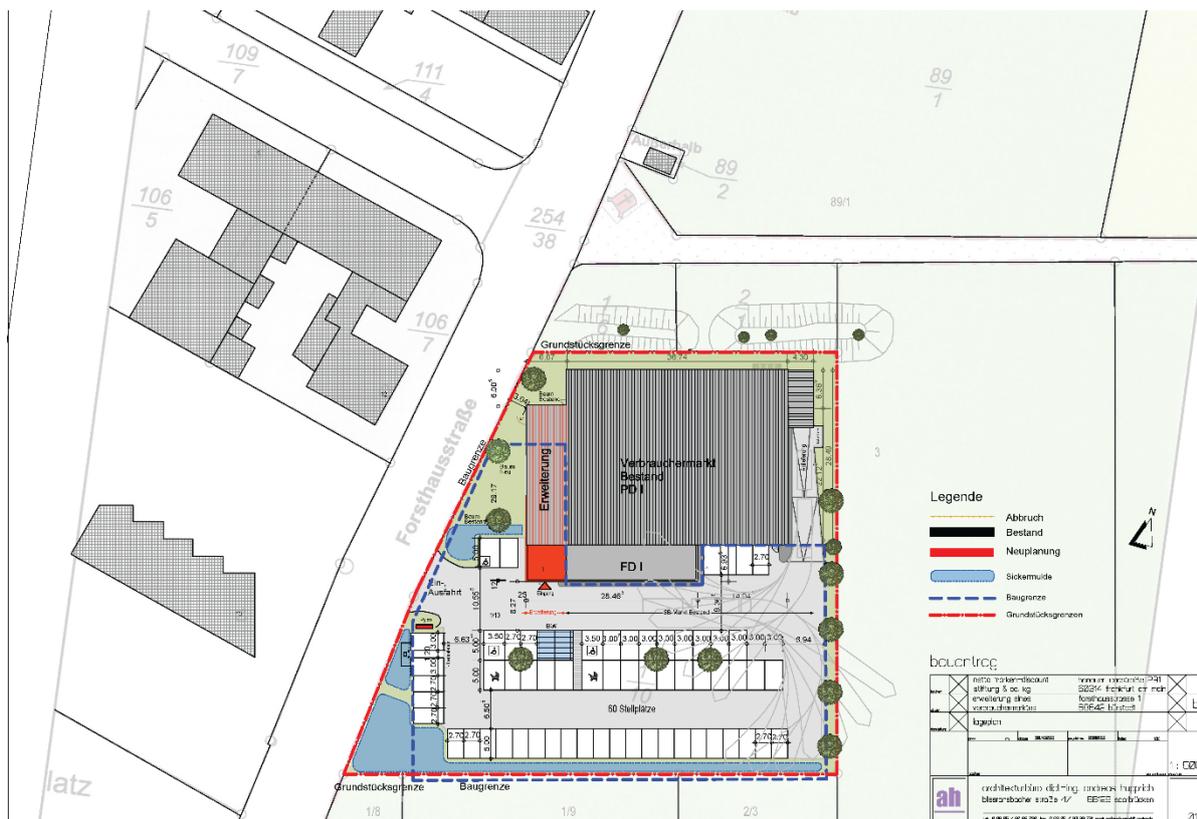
Lageplan Nettomarkt mit baulicher Erweiterung (unmaßstäblich)
